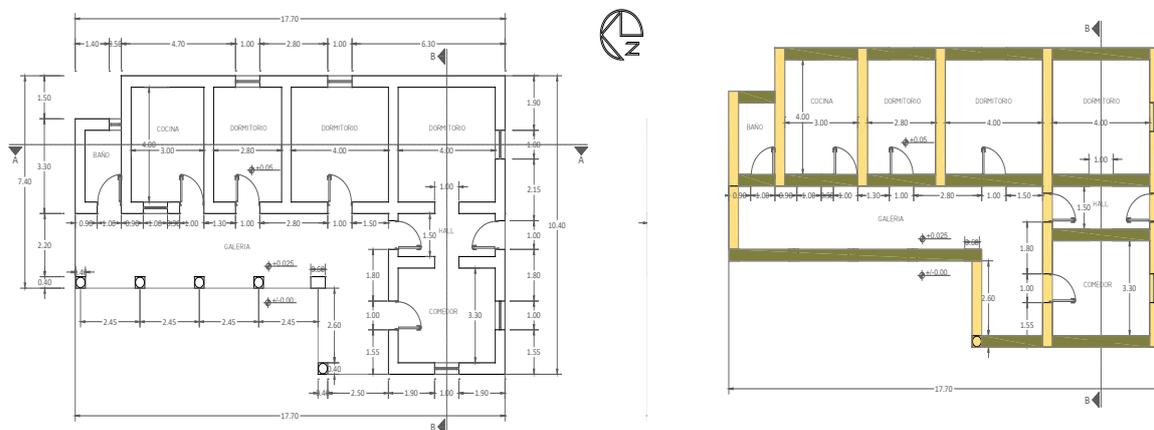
Planta general de la vivienda de la Muestra 3: a) análisis funcional b) dirección de los muros
